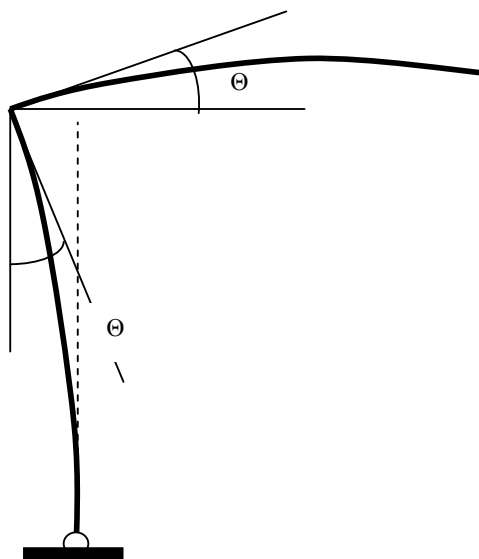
Deformação do pilar esquerdo e do primeiro tramo da viga.
